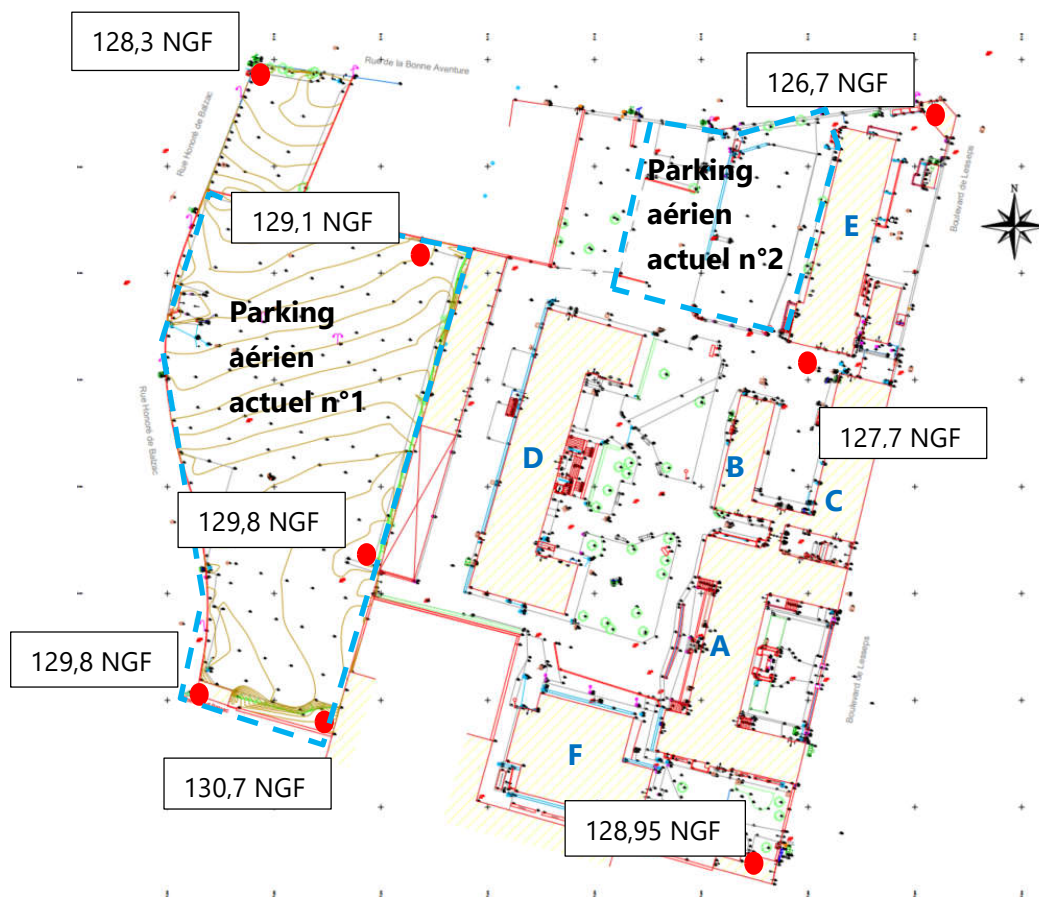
Extrait du plan topographique du site (Source : BEP Ingénierie)
